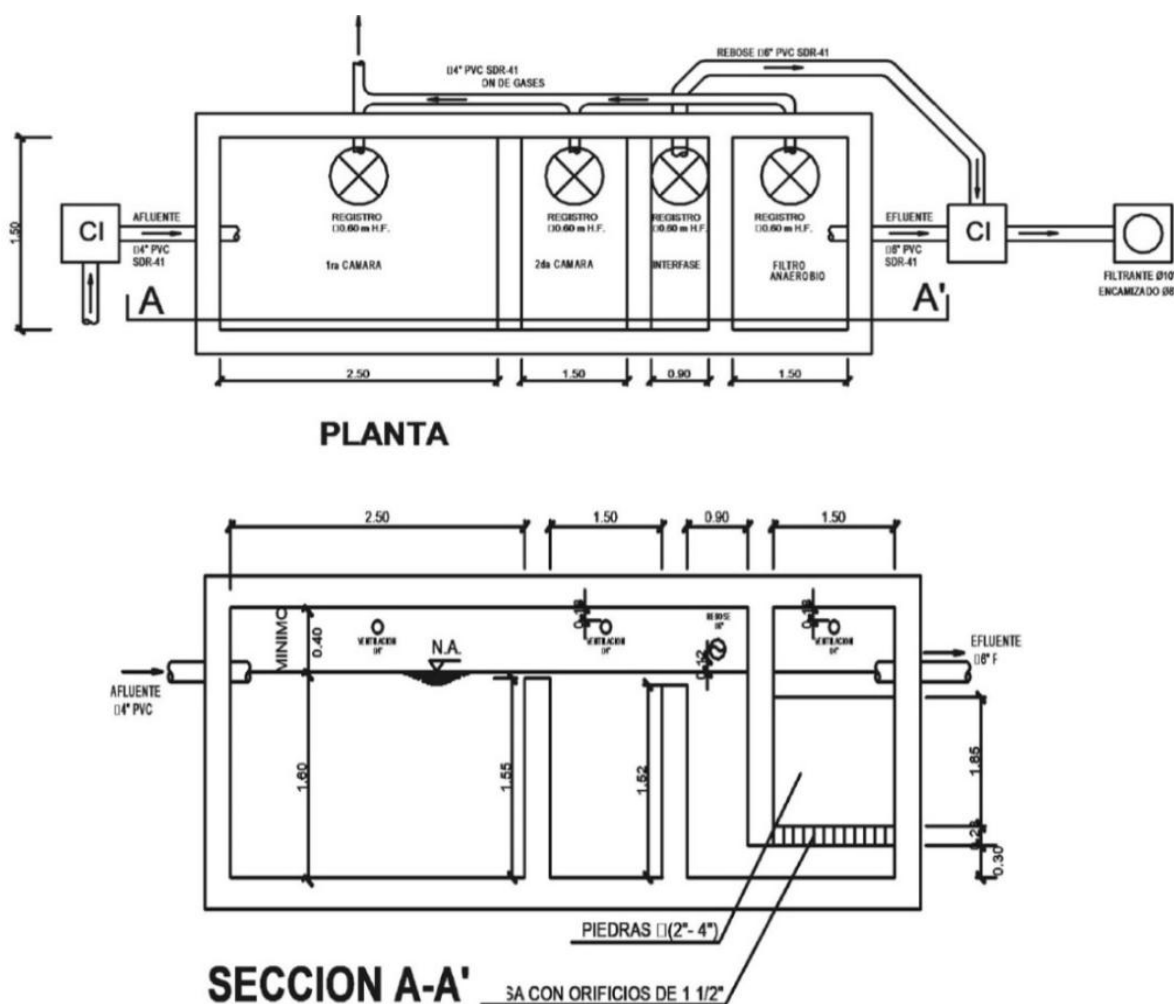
Vista en planta y elevación del sistema de tratamiento
